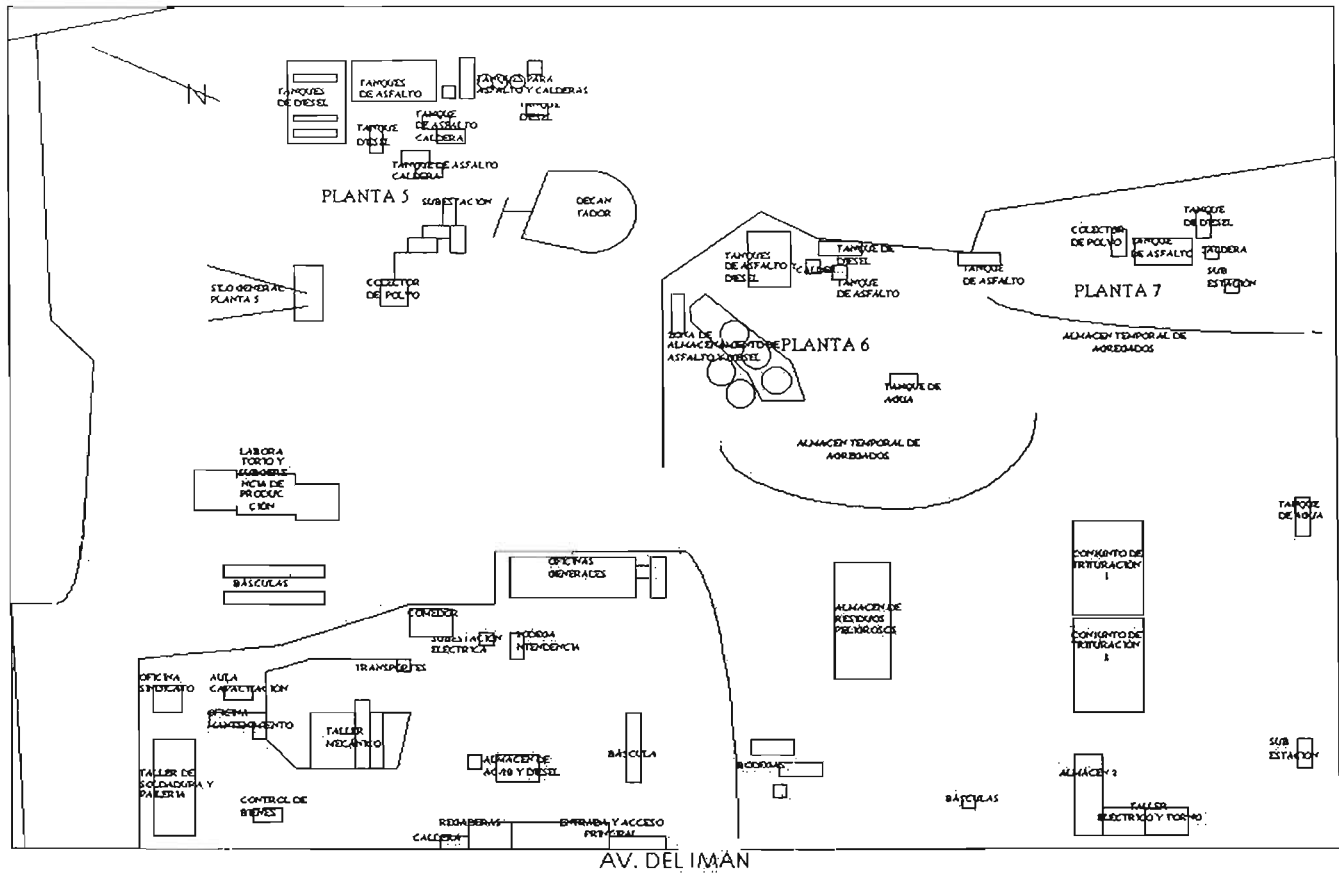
Croquis de las instalaciones de la planta de asfalto en la delegación Coyoacán.
